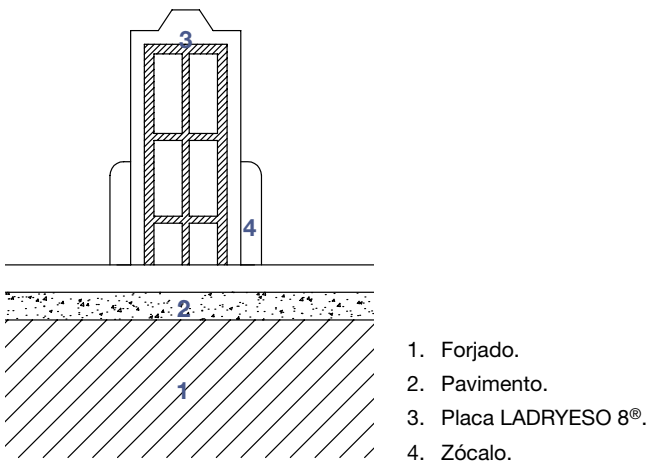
Colocación del tabique LADRYESO 8® sobre pavimento.
